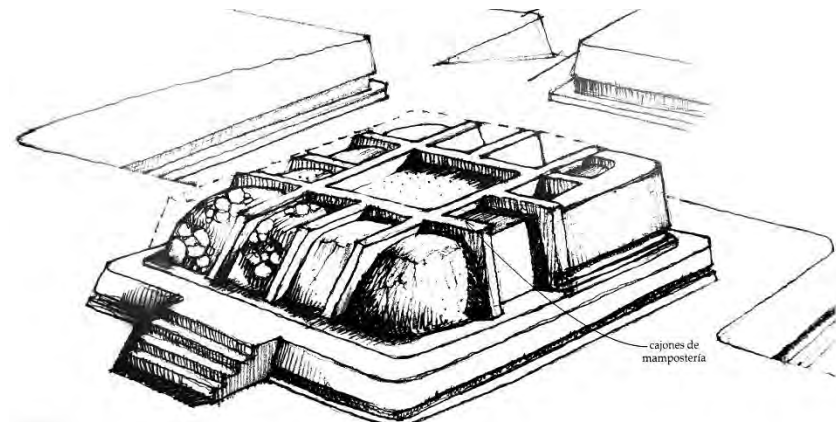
Esquema de construcción del sistema de cajones de piedra. (Villalobos, 2010).
